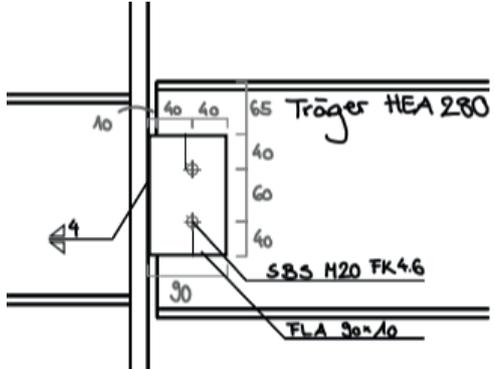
Detail Anschlussknoten kleine Halle an grosse Halle
